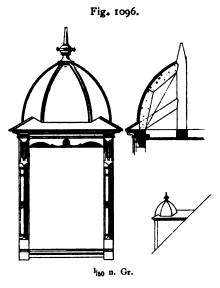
endlich bringt einen ungleichseitigen, achteckigen Kuppelaufbau auf flachem Satteldache. Der Durchschnitt lehrt die Construction aller der-
